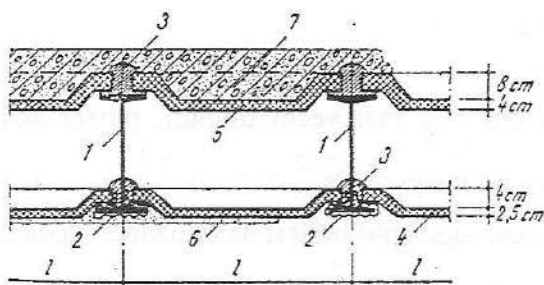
Secțiune transversală dintr-un planșeu din grinzi metalice și plăci prefabricate din beton armat:
